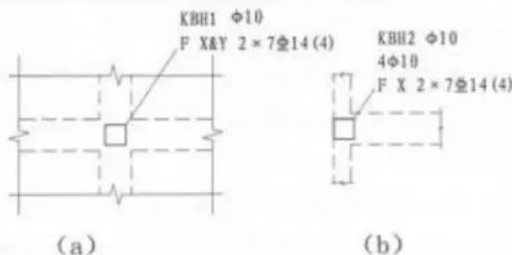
框架扁梁节点核心区附加钢筋注写示意图
